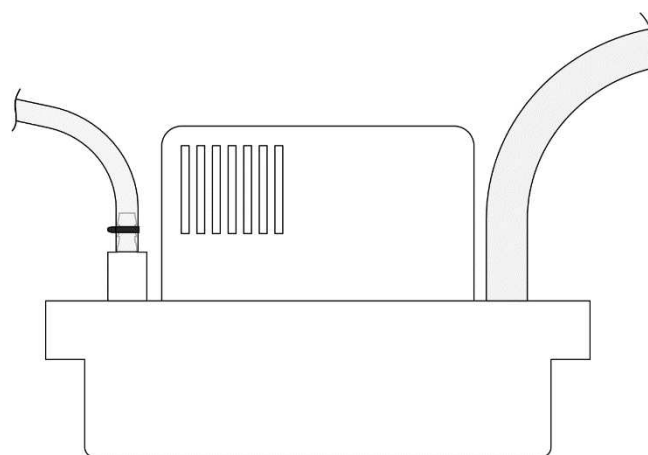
Montage du raccordement d'arrivée et d'écoulement
